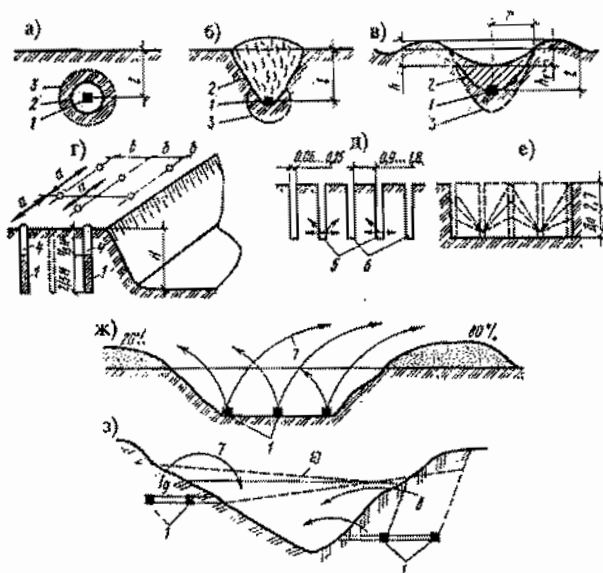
Схемы разработки грунтов взрывным способом: 1 - заряд ВВ; 2 - граница зоны полного разрушения; 3 - зона деформации грунта; 4 - забойка шпура; 5 - зарядная шель; 6 - компенсирующая шель; 7 - направление перемещения взорванного грунта; 8, 9 - массивы грунта правого и левого склонов, предназначенные к взрыву; 10 - проектный профиль насыпи
